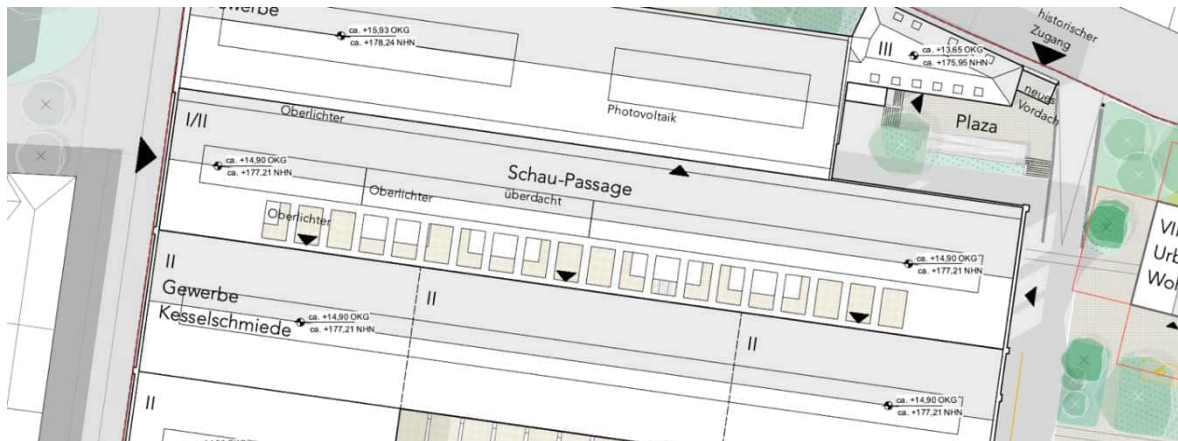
Dachaufsicht R5 Schiff 9, Oberlichter im Dach, coido architects
